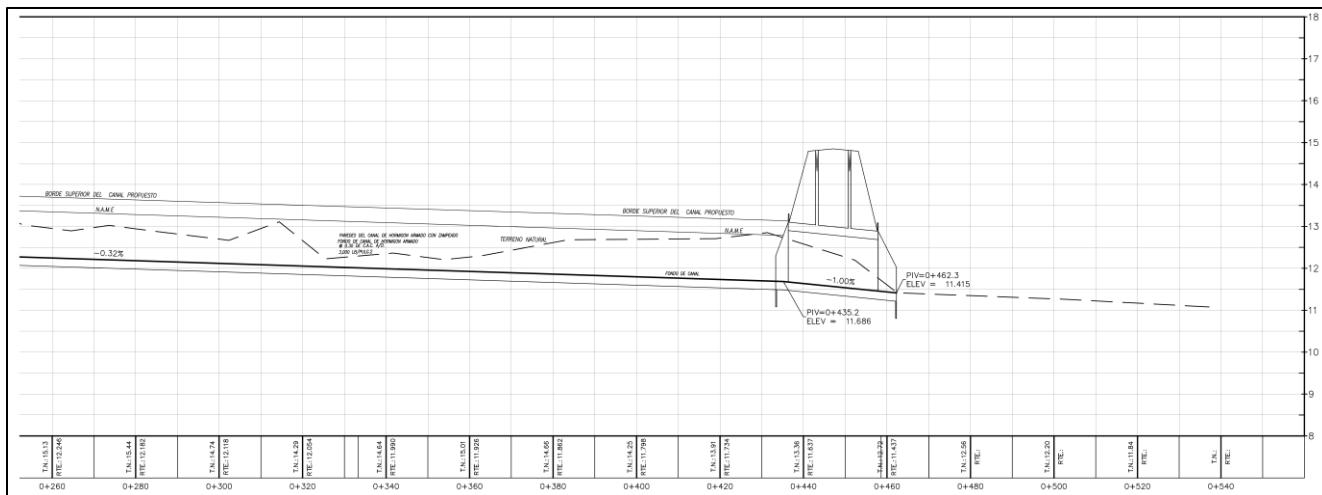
y 14: Extracto del plano para la sección longitudinal conformada en concreto, propuesta para el drenaje pluvial "Sin Nombre 2"
